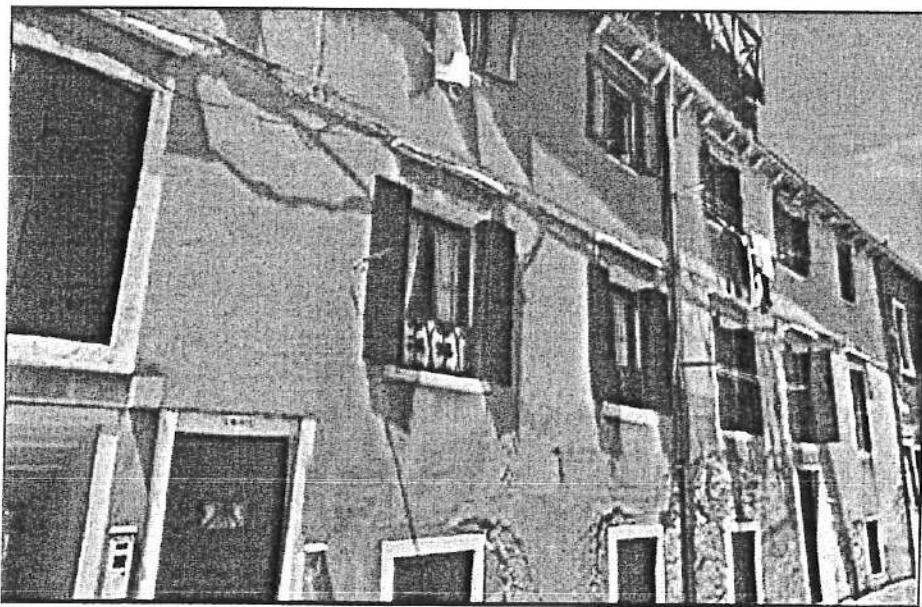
Vista laterale del fabbricato da Corte Ferrando
